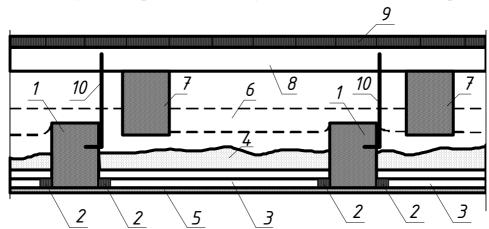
Устройство деревянных перекрытий по деревянным балкам:
